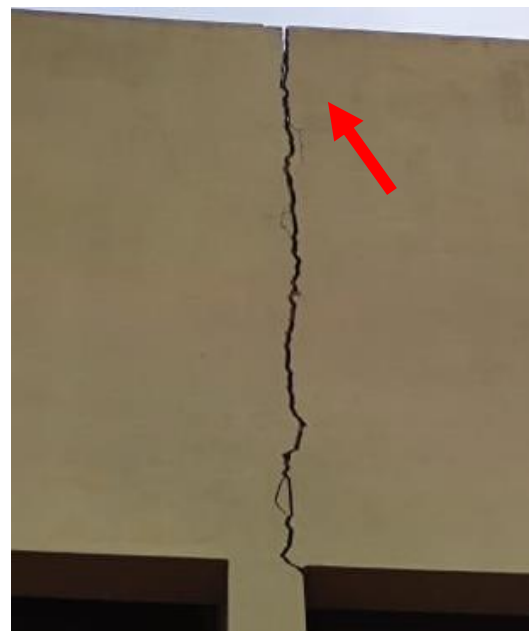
Trincas em alvenaria tiradas no pavilhão 6, UFLA.
